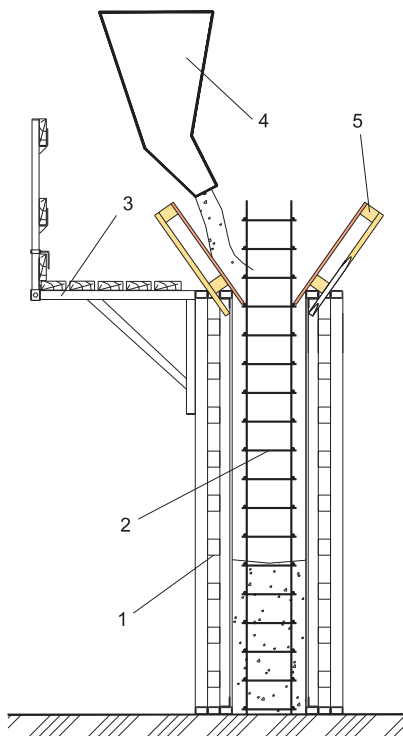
Схема укладки бетонной смеси в опалубку способом «кран-бадья»:
